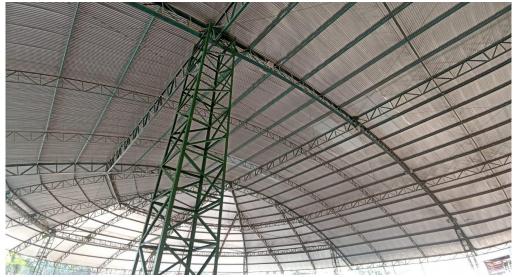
Detalhe para das estruturas metálica (torres) fixas no topo e na base e devidamente pintadas
